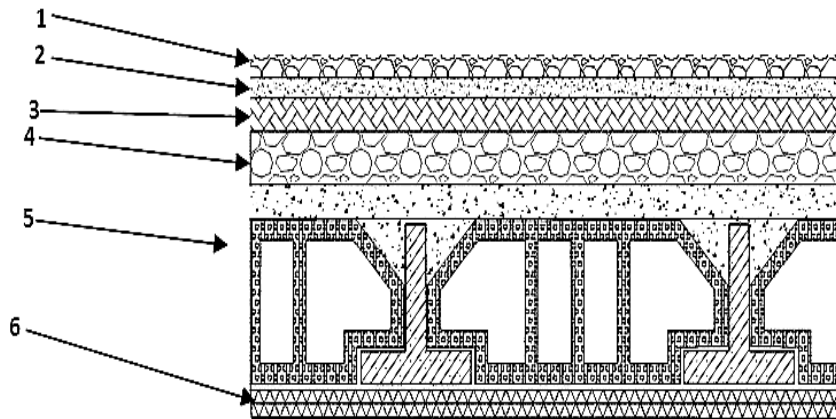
Coupe transversale d'un plancher terrasse inaccessible
